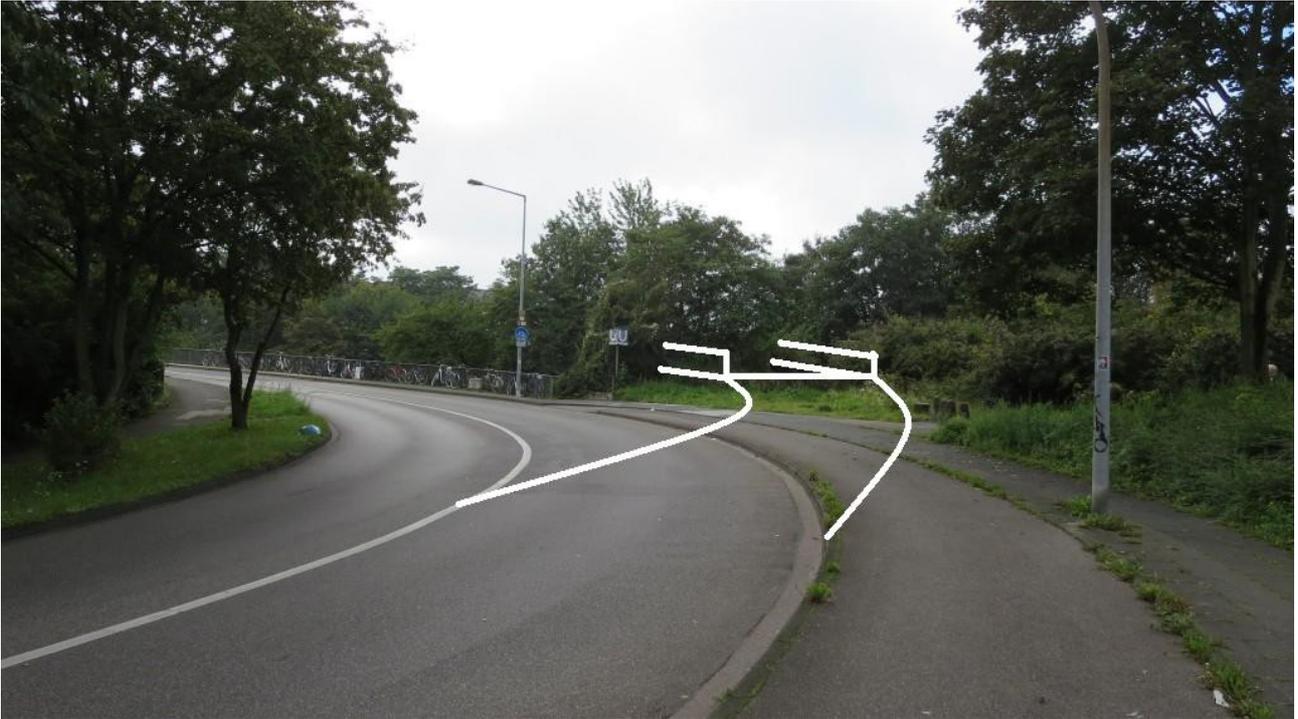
Baustellenzufahrt über Bahnbrücke (hier zugewuchert).
